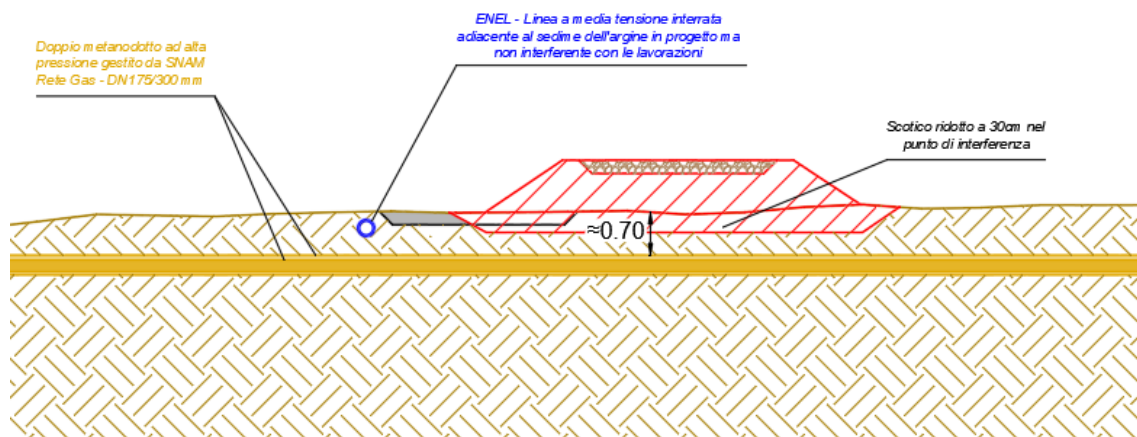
UBICAZIONE DELLE TUBAZIONI INTERFERITE RISPETTO ALLE OPERE IN PROGETTO - VISTA IN SEZIONE
